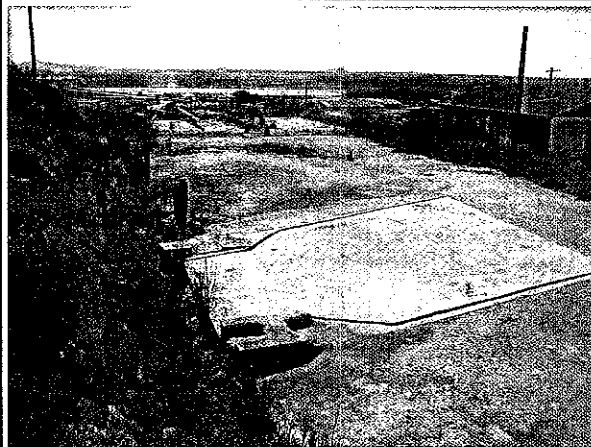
Área cimentada onde funcionava as antigas instalações do canteiro.
